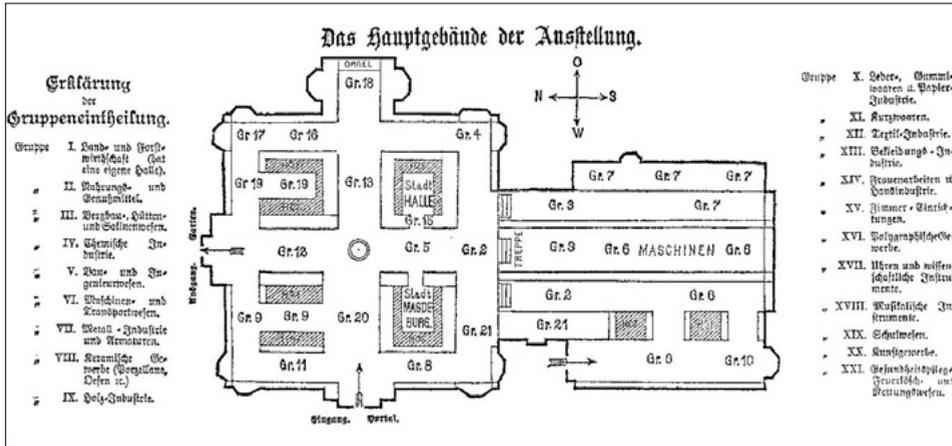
Grundriss des Hauptgebäudes mit 20 Ausstellungsgruppen und den Pavillons der Stadt Halle und der Stadt Magdeburg in der Mitte (Foto: Stadtarchiv Halle).
